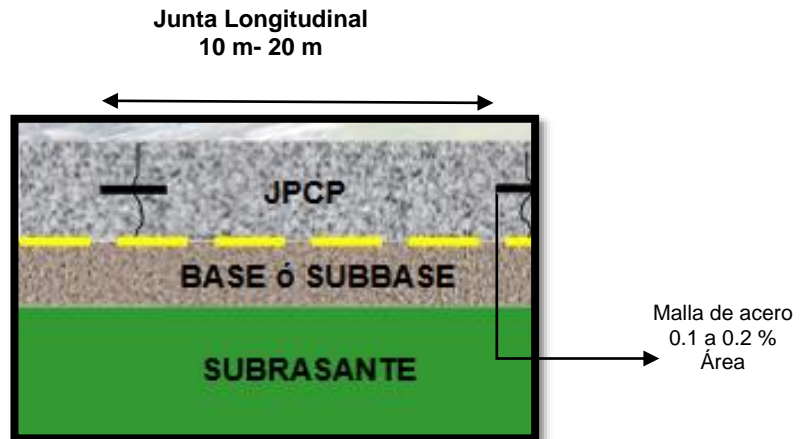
Pavimento de Concreto Con Refuerzo discontinuo (JRCP)
